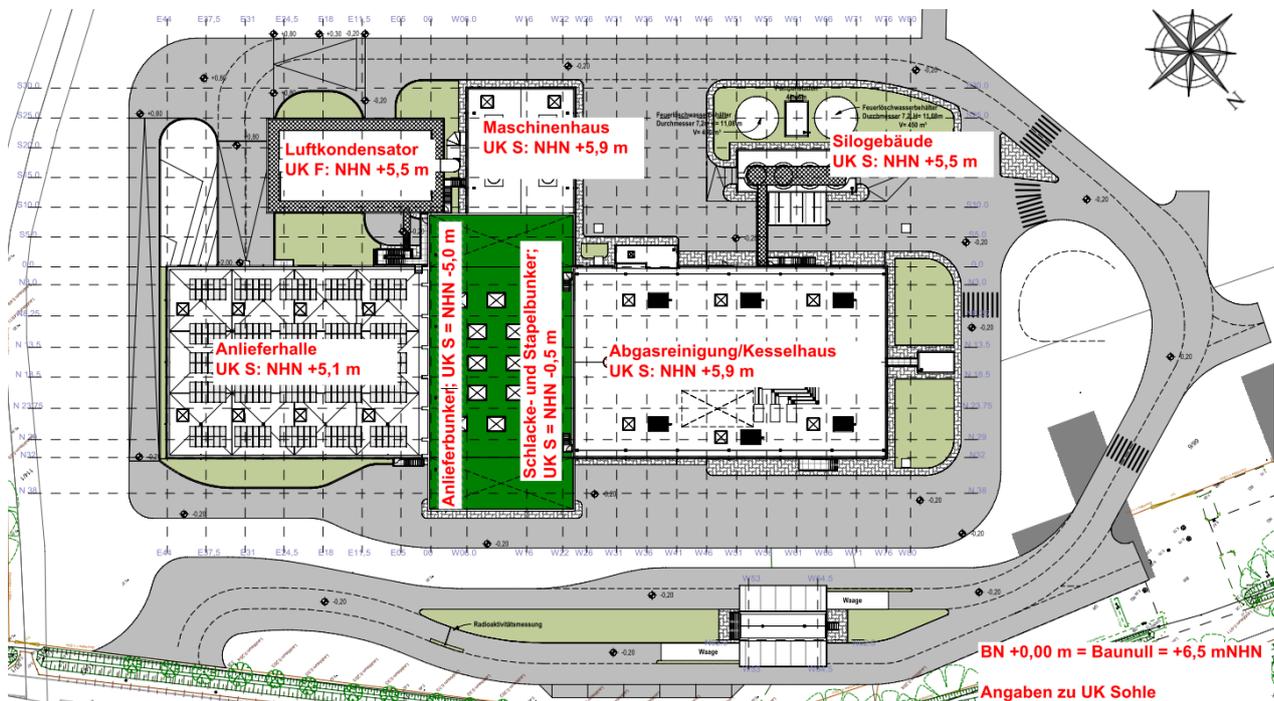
Lageplanskizze mit Darstellung der geplanten Sohlunterkanten der Gebäude, o. Maßstab, [U2]
